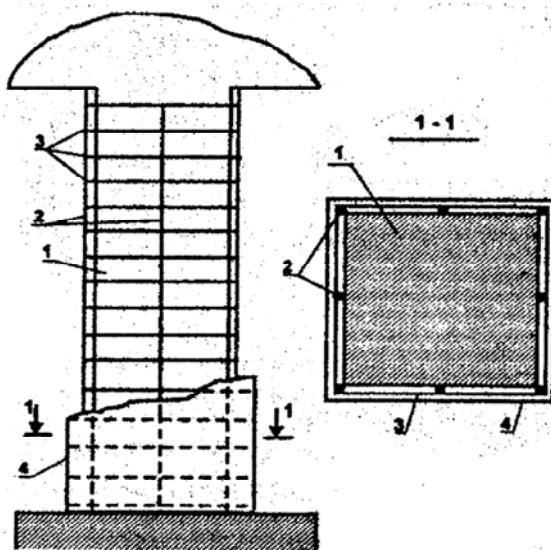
Бетонная (растворная) армированная обойма:
